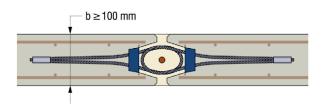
Wand – Wandverbindung (vertiefter Einbau)
